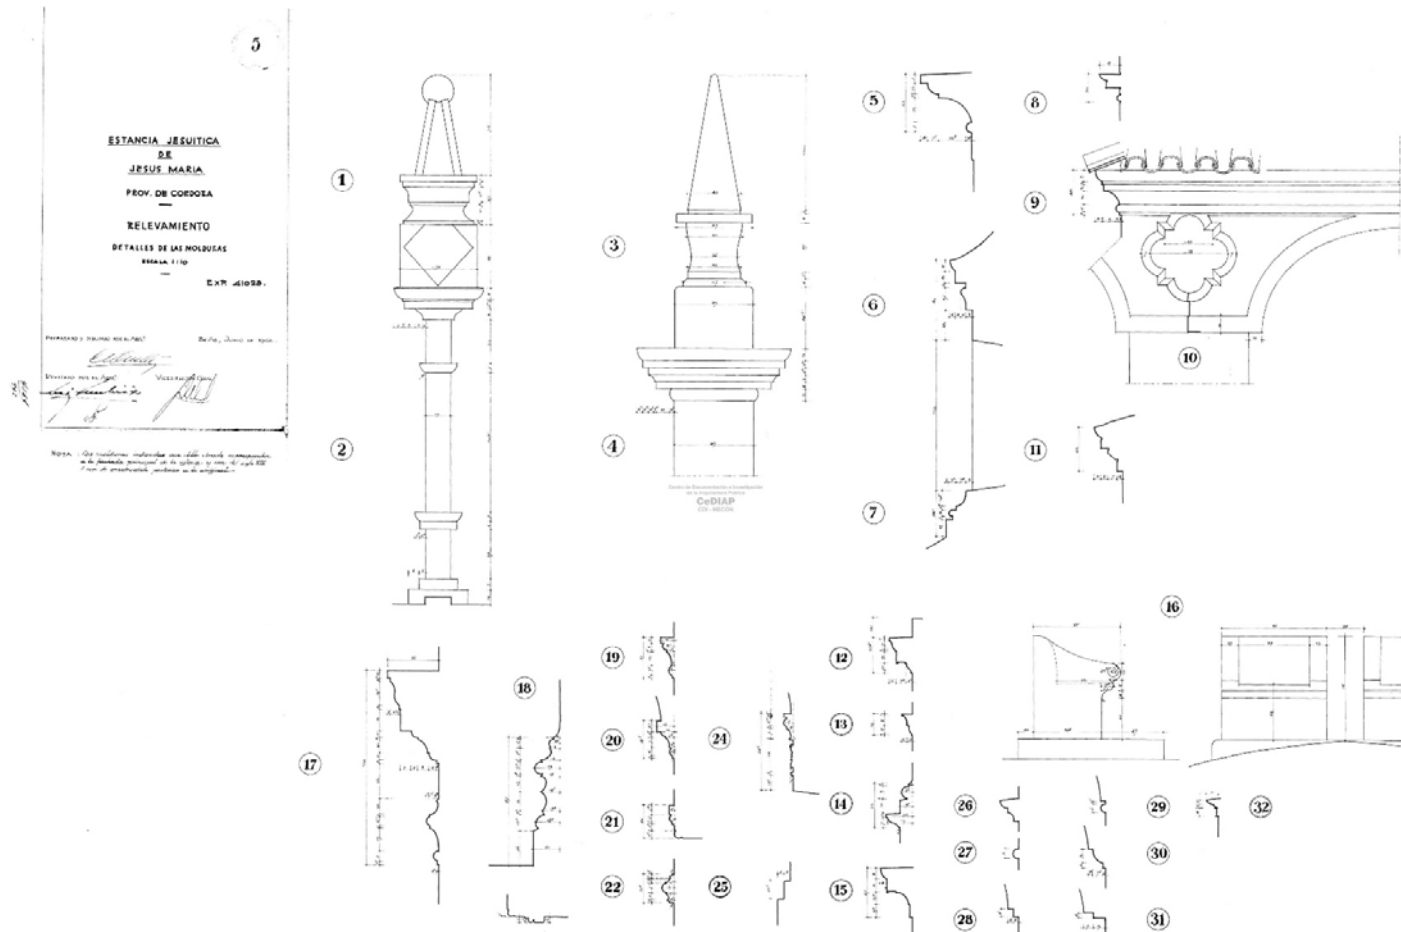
Plano de relevamiento de Molduras y detalles por el Arq. Carlos Onetto. CEDIAP
